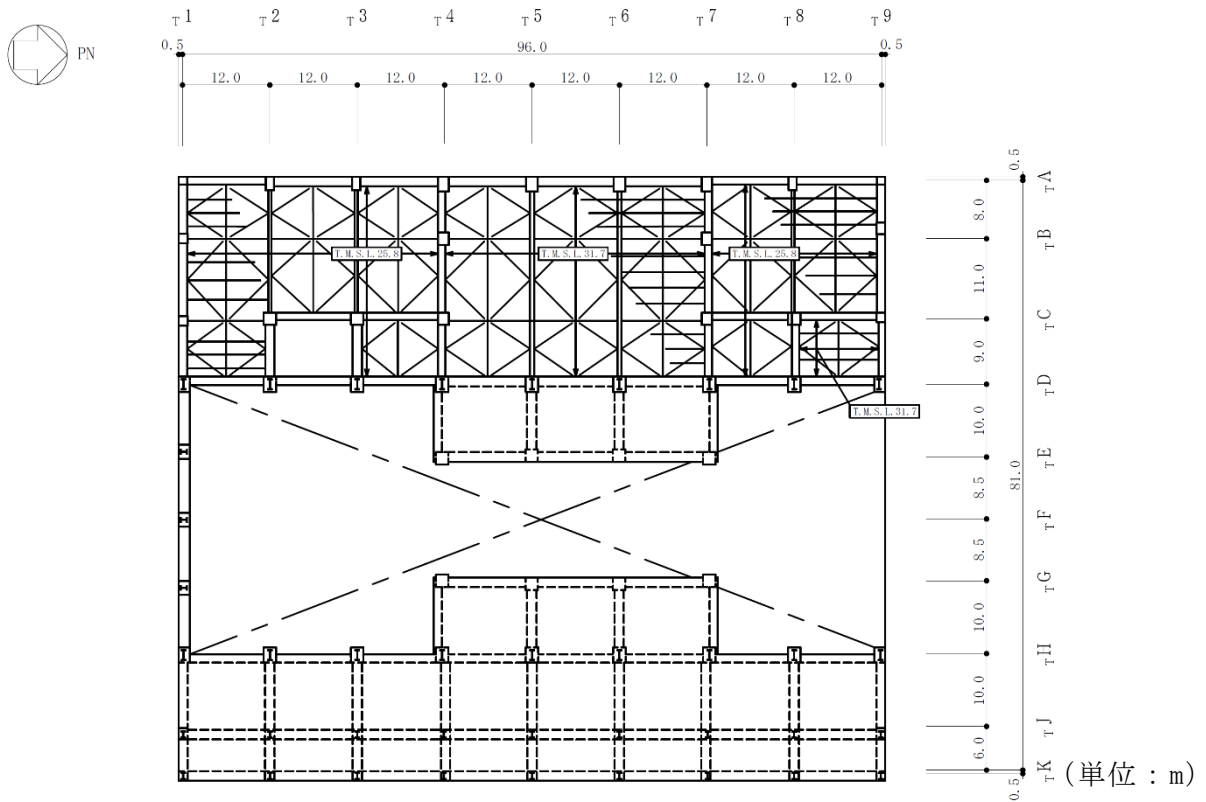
タービン建屋の概略平面図 (3F, T.M.S.L. 30.9m) (5/6)
